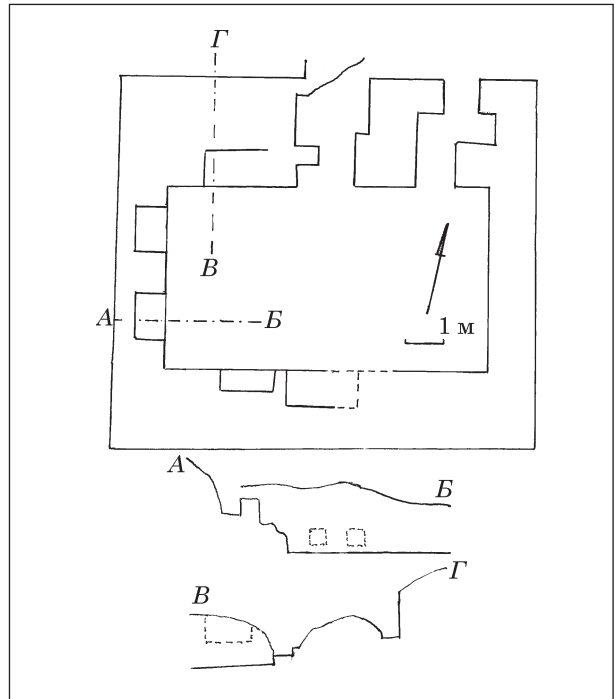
Фундамент кам'яної споруди (план і профілі)
